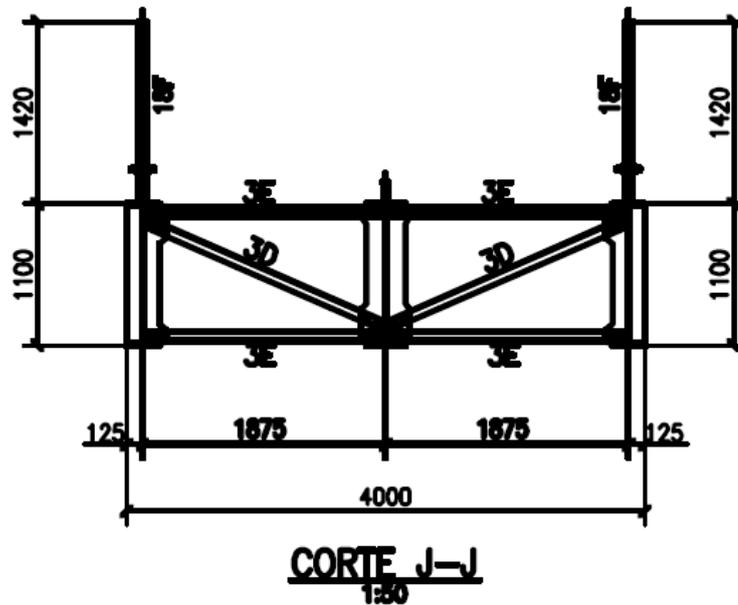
PASSARELA FIXA – VIGAMENTO METÁLICO – SEÇÃO TRANSVERSAL
